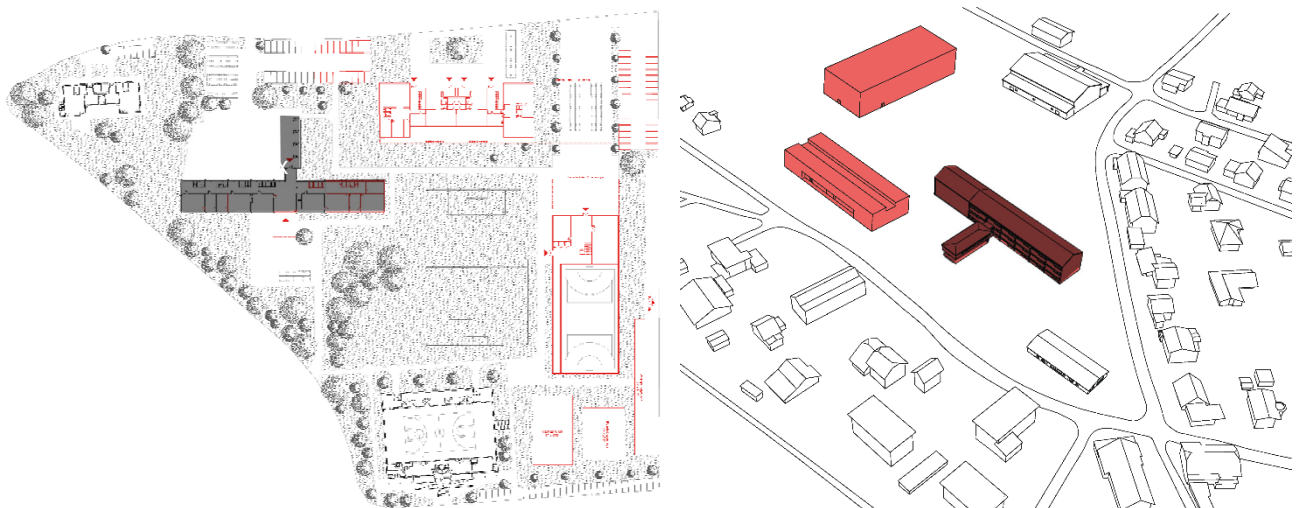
Masterplan Schulcampus (HSB) mit Situationsplan EG (links) und Isometrie (rechts)
